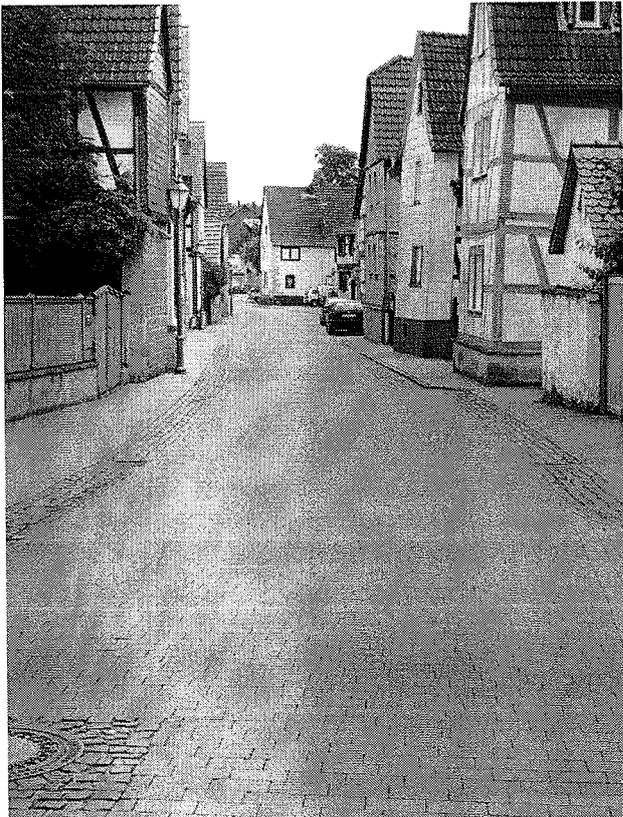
Ortsdurchfahrt Höhe Altenstädter Straße 18
